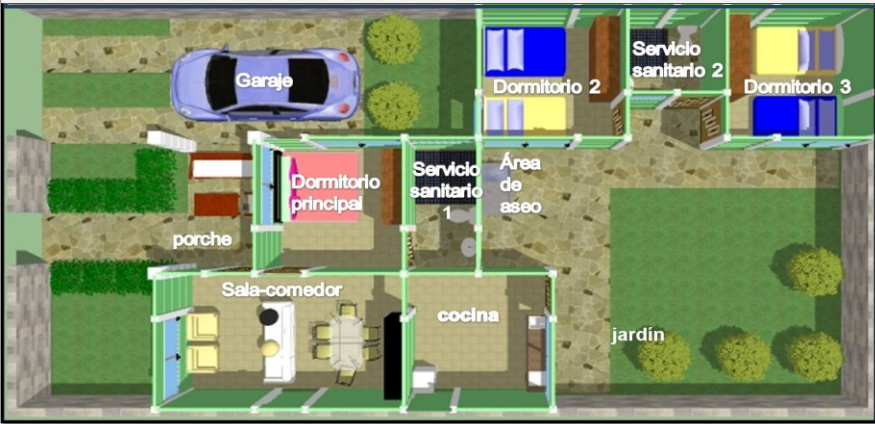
Vista planta arquitectónica del modelo de vivienda Primavera, de la urbanización Valle verde en San Pedro de Lóvago, Chontales.
